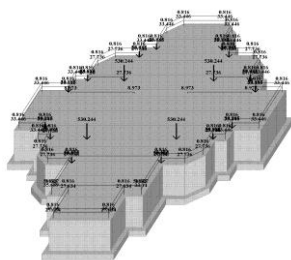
Расчетная схема цокольной части здания на плитном фундаменте
